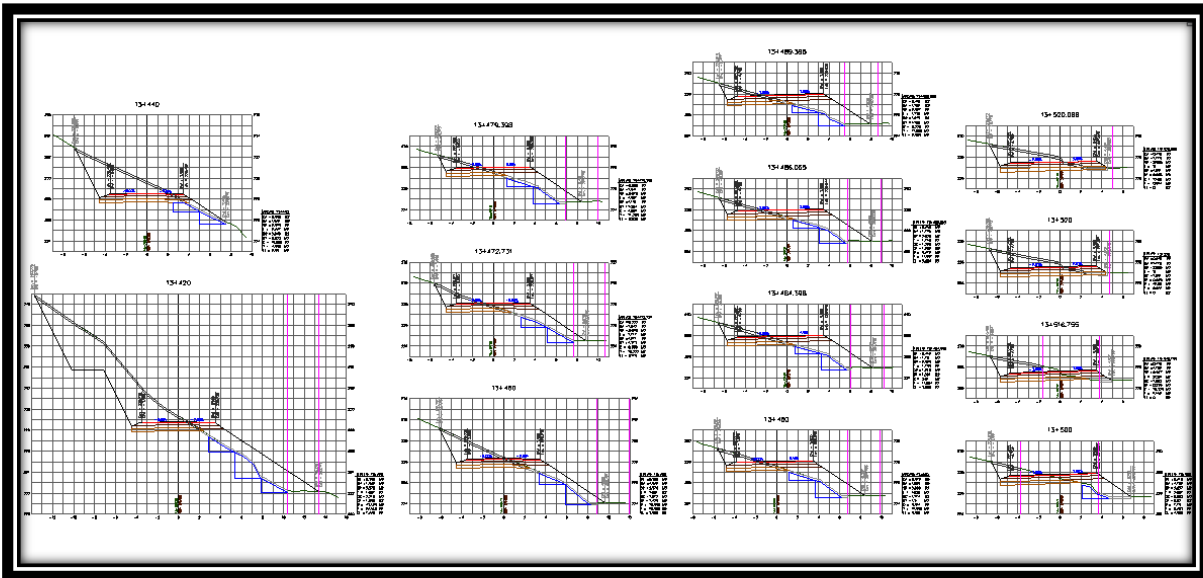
Secciones de construcción del km 13+420.000 al km 13+520.088.
